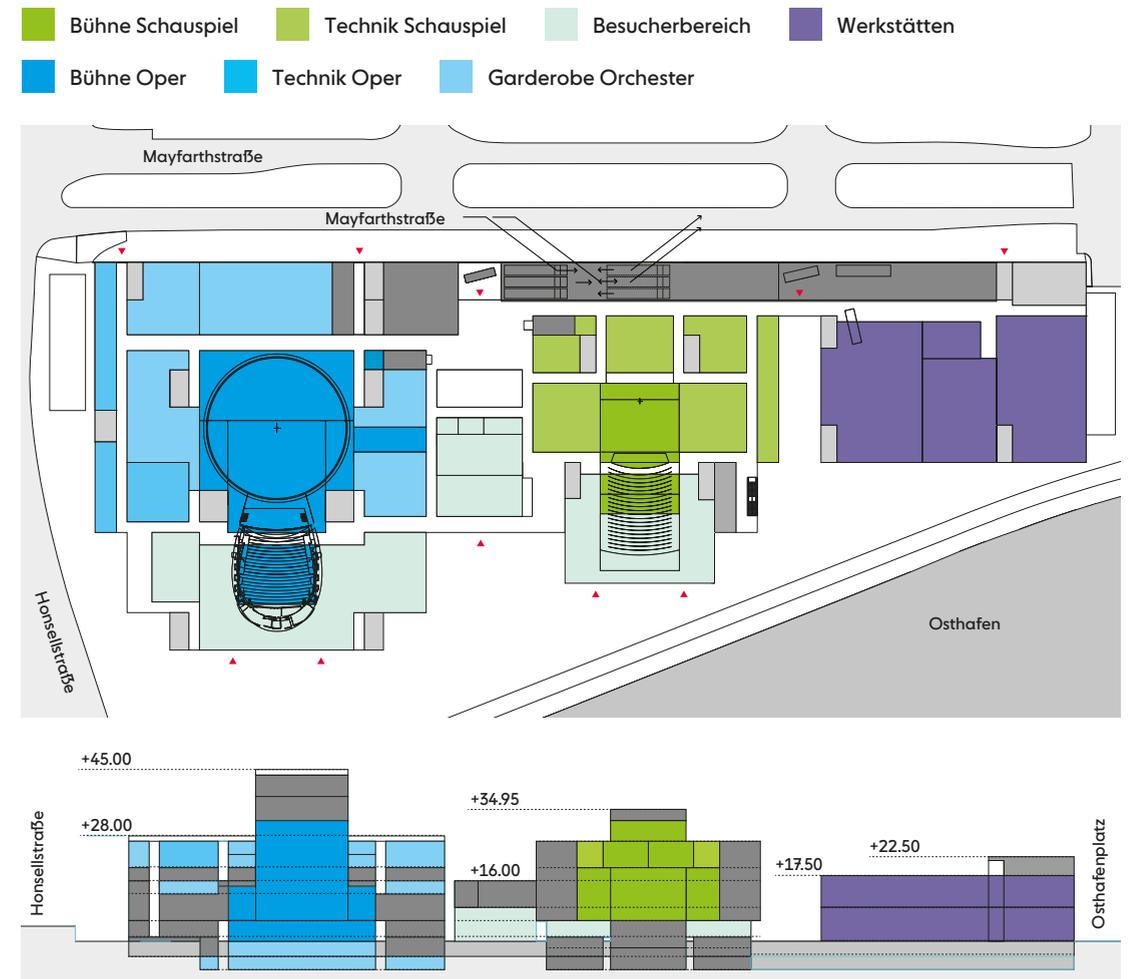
5h Osthafen, Doppelanlage mit Werkstätten und Probebühnen; Grundriss Erdgeschoss, Schnitt
